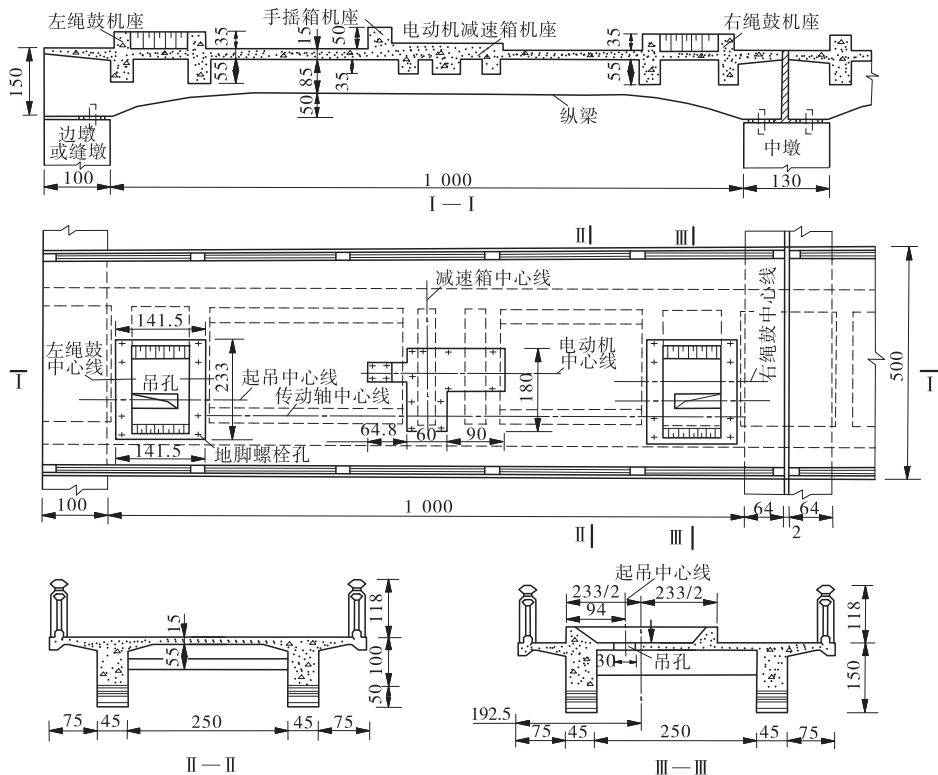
设有 2×22.5 kN 绳鼓式启闭机工作桥布置图 (单位: cm)
